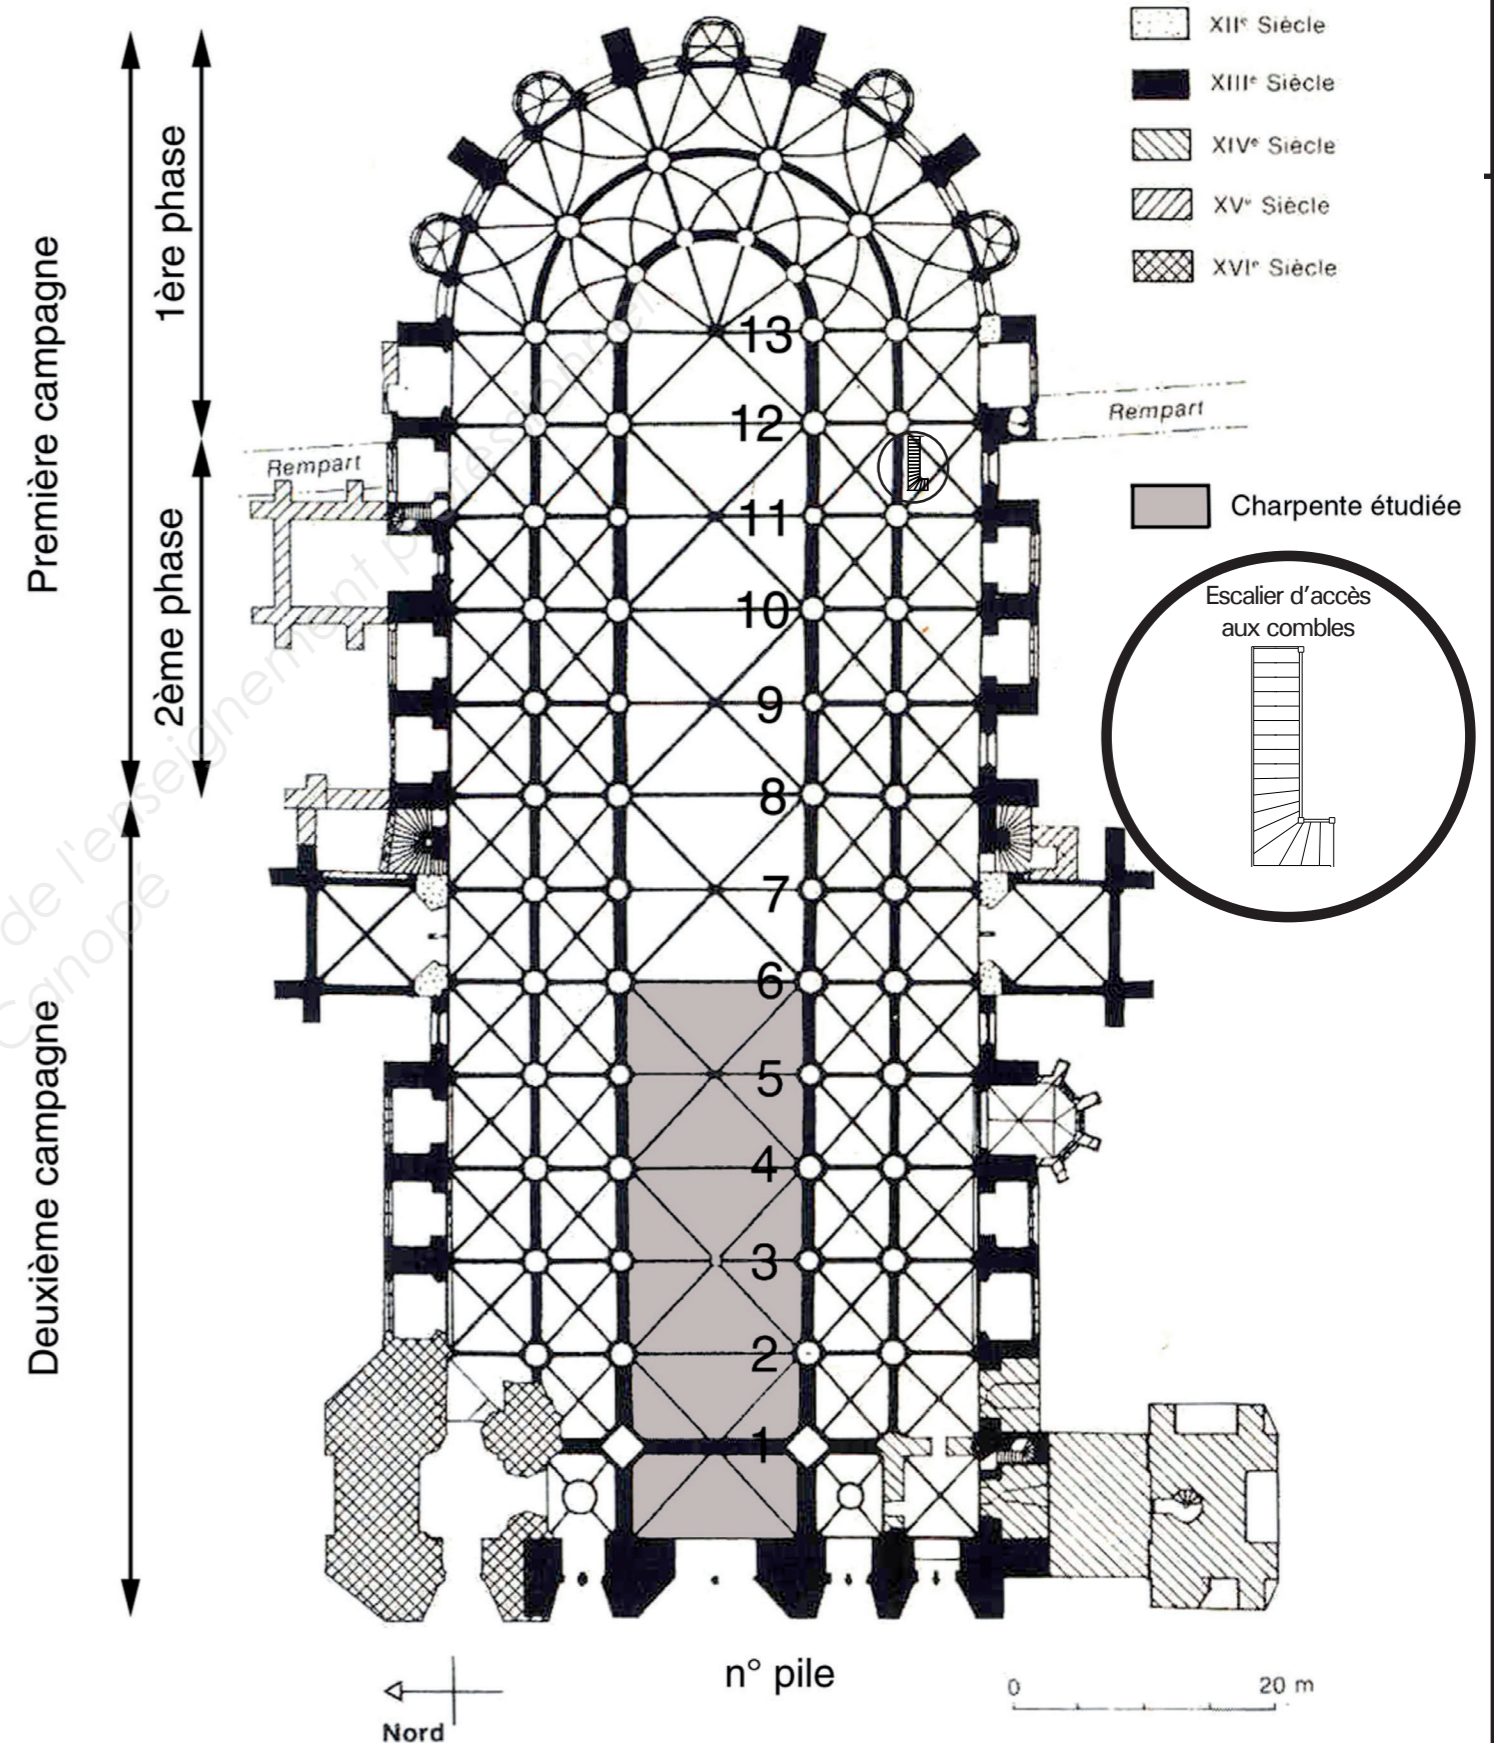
Plan de la cathédrale de Bourges (d'après plan Ribault 1995 : 27).
